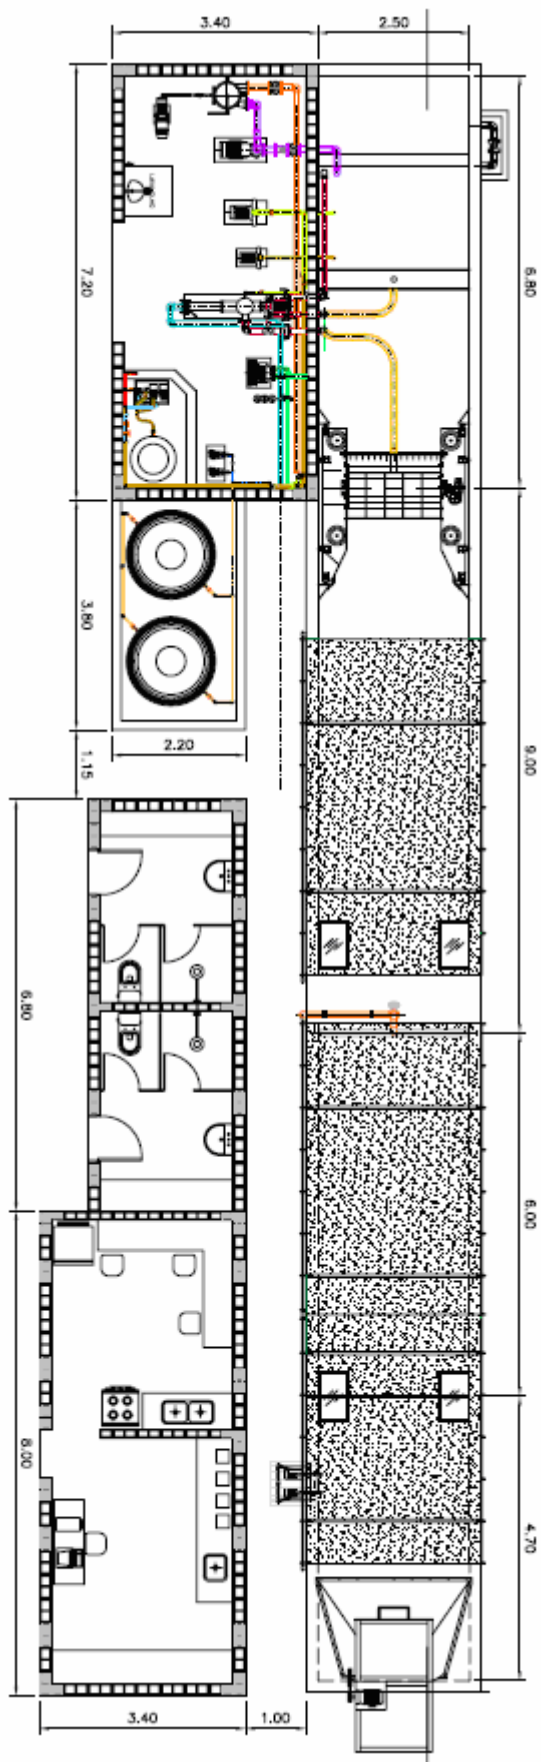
Planta da unidade de flotação. Fonte: DMAE.
